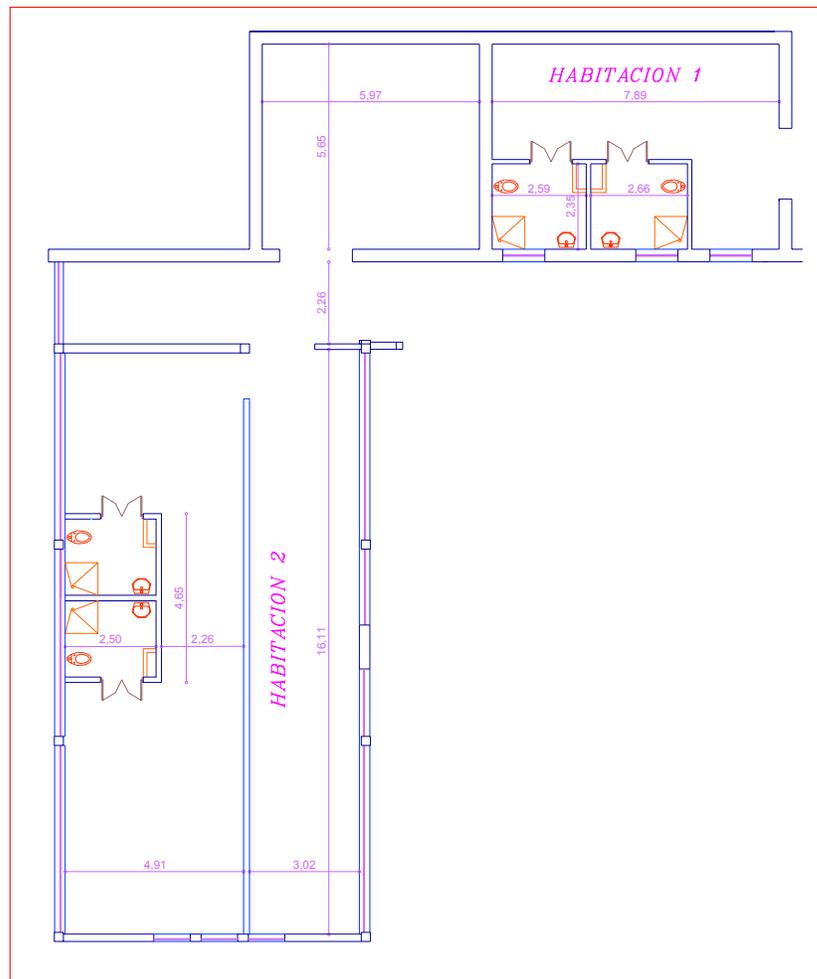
Referencias Planta Arquitectónica Segundo Nivel
